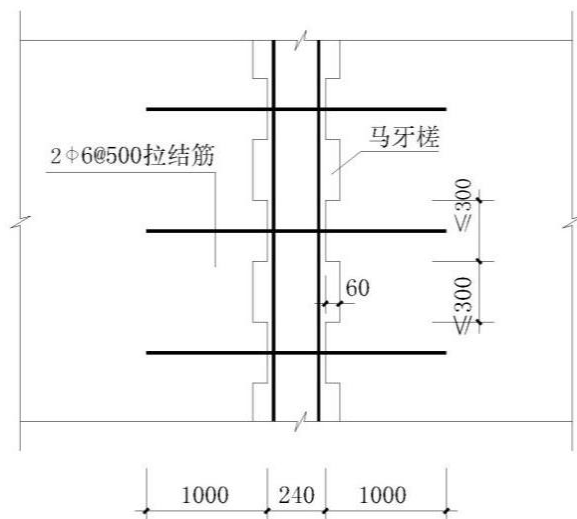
拉结钢筋布置及马牙槎示意图（单位：mm）
